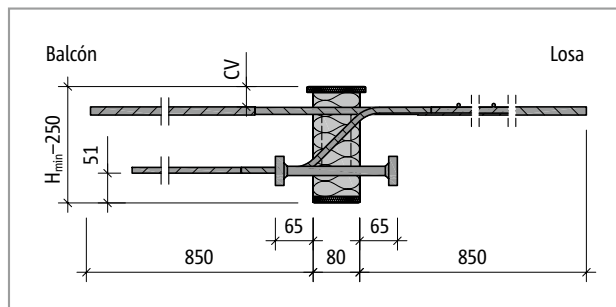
Schöck Isokorb® T tipo K-M12: Sección del producto
